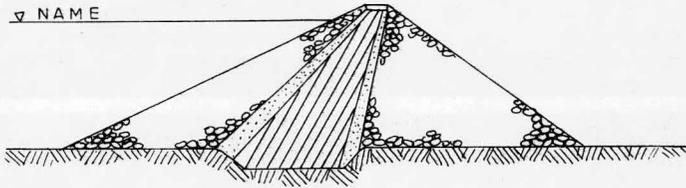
Sección de cortina de enrocamiento, corazón inclinado.
